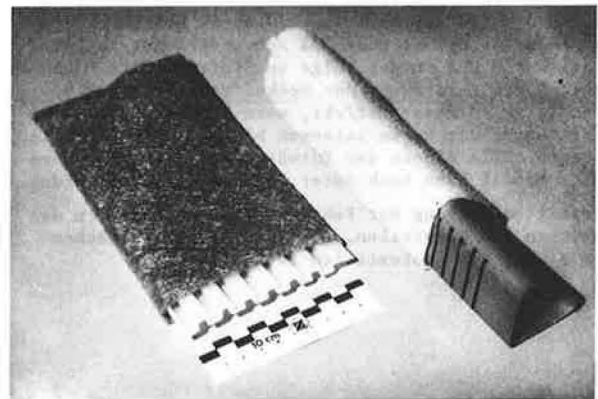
Vliesumhüllte Drainagesysteme zur Entwässerung der Betondeckenunterlage
